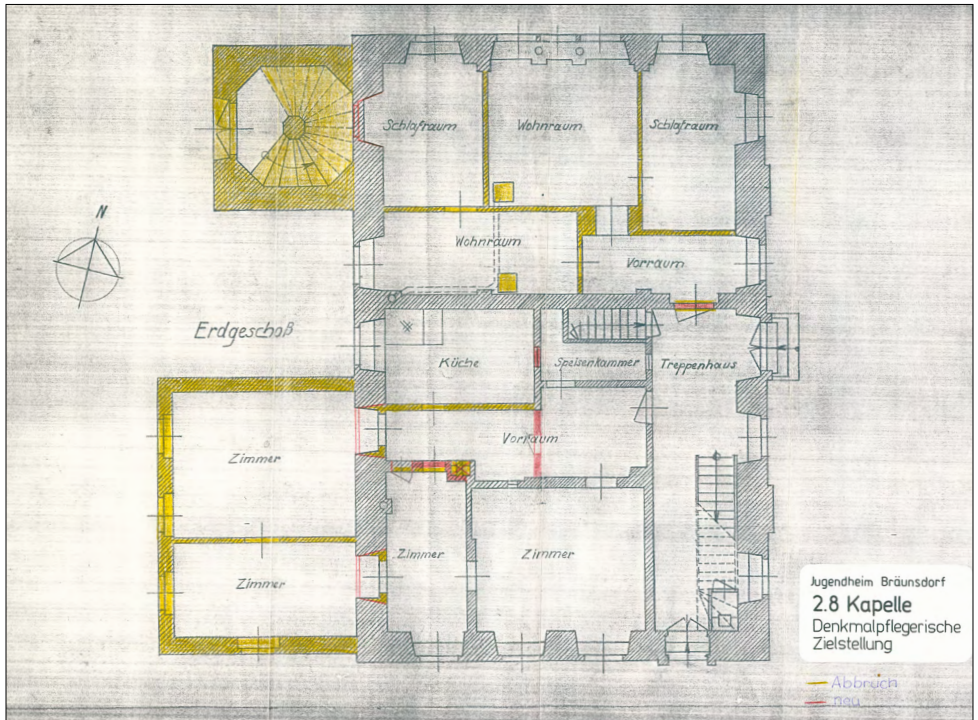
Der denkmalpflegerischen Zielstellung aus dem Jahre 1997 wird ein älterer Grundrissplan des Erdgeschosses (1980er Jahre) zugrunde gelegt. Erkennbar ist die bis heute gültige Grundrissgliederung, der Turm und der Schulraumbau sind noch existent.
